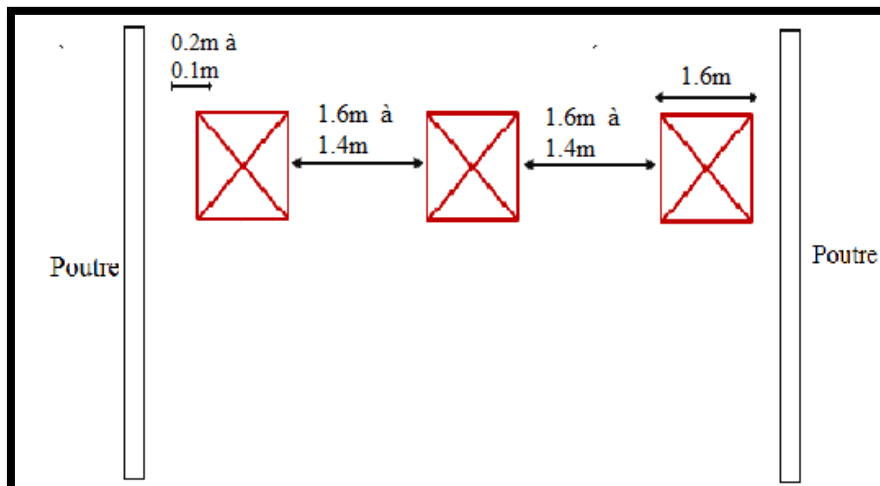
EXEMPLE POUR UNE DALLE PLEINE EN BA DE PORTEE 5.2M
